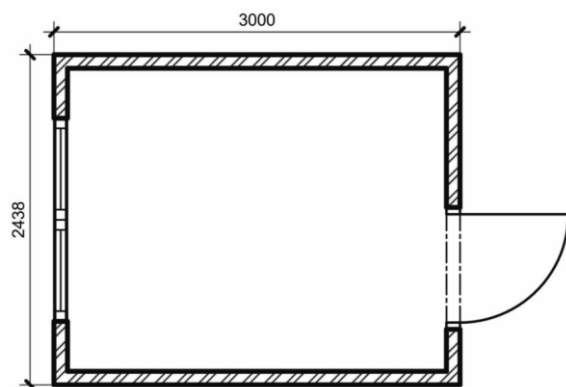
Půdorys stavební buňky Toi Toi BK1 [11]
